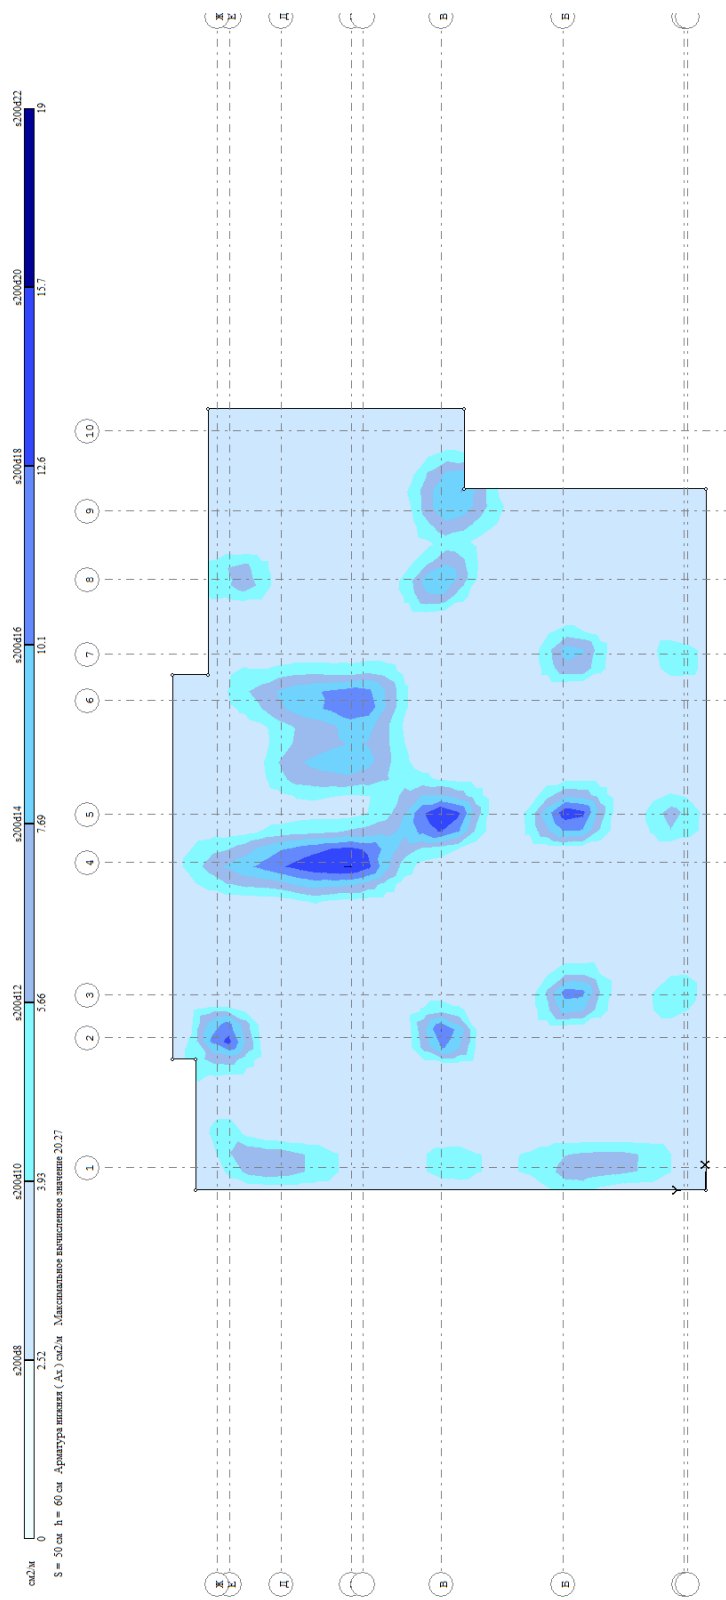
Нижня арматура по X - фундаментна плита
